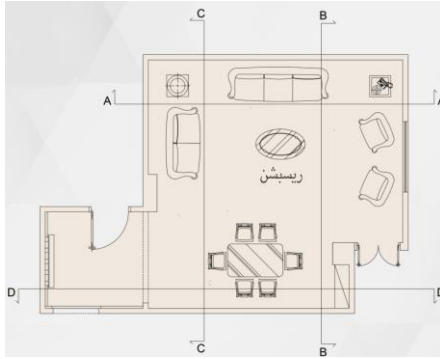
مسقط أفقي لشقة سكنية بمنطقة المقطم
